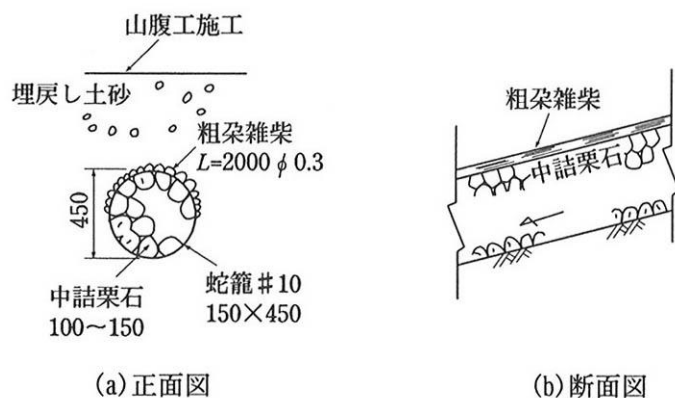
蛇籠暗渠工 (例 単位mm)
